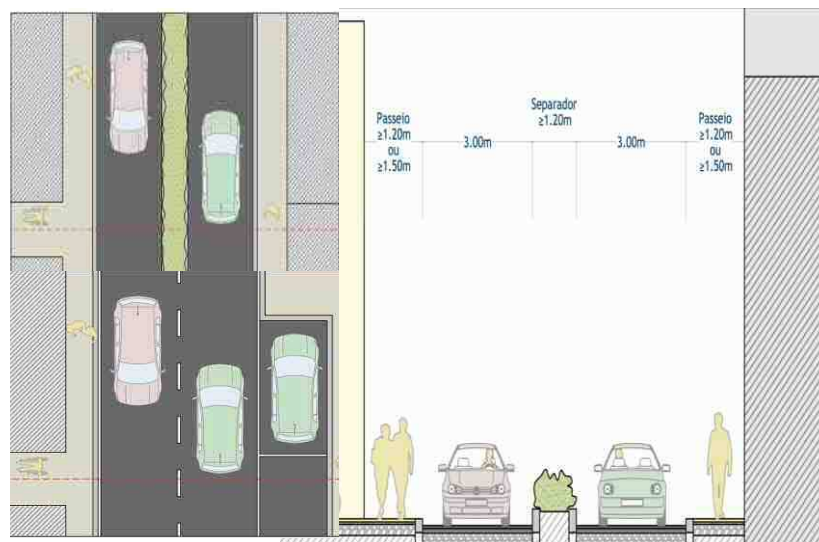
Exemplo de Rua com perfil entre 8,40m e 9,60m
